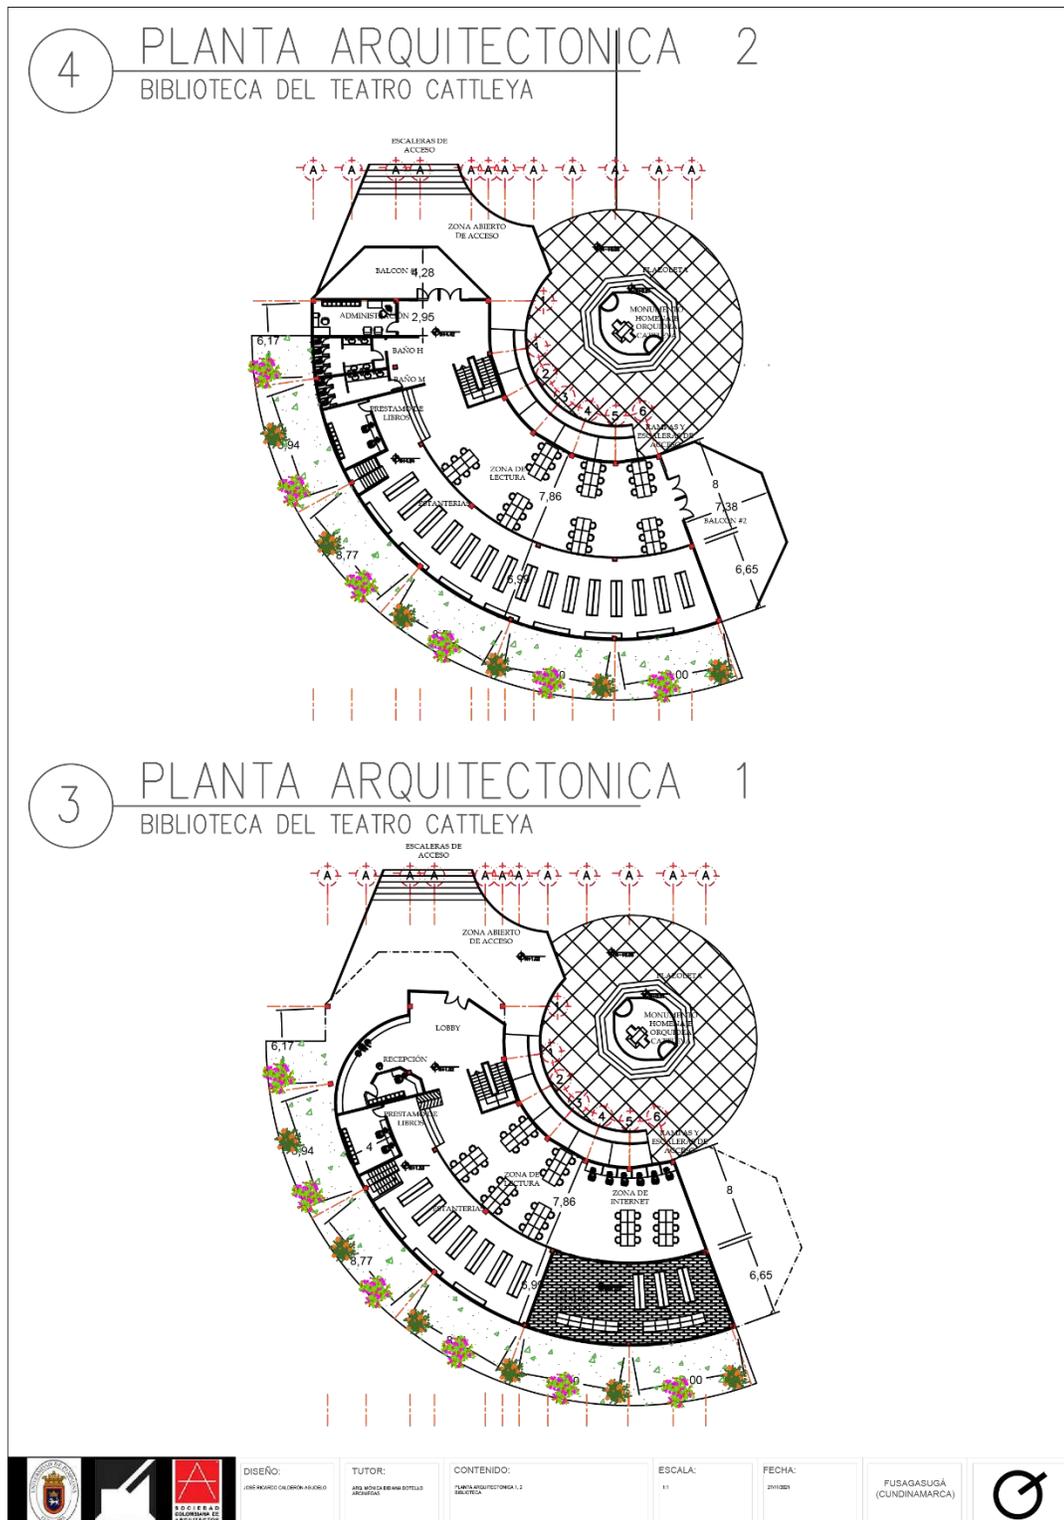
Planta arquitectónica 1,2 biblioteca del teatro Cattleya
